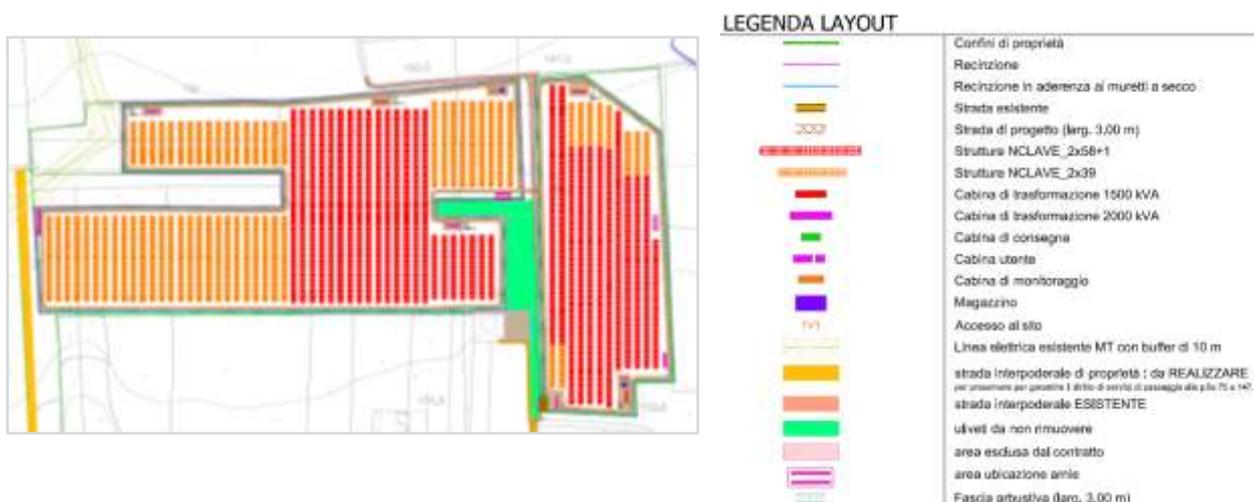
Stralcio dal documento TW06O18\_RelazionePaesaggisticaElabProgetto\_05 Layout di progetto
